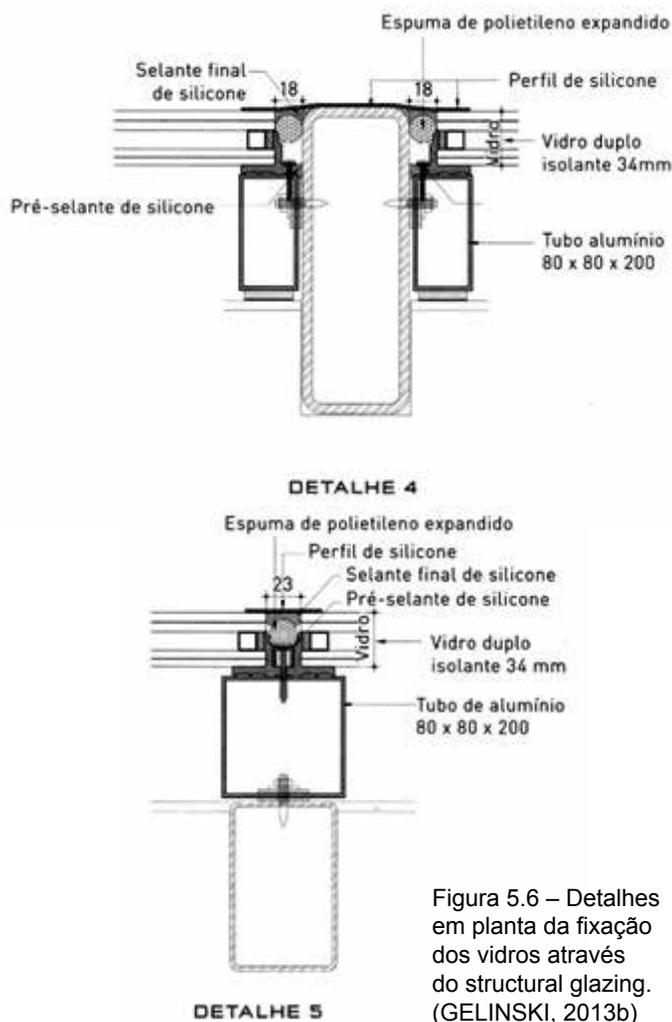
Detalhes em planta da fixação dos vidros através do structural glazing. (GELINSKI, 2013b)
